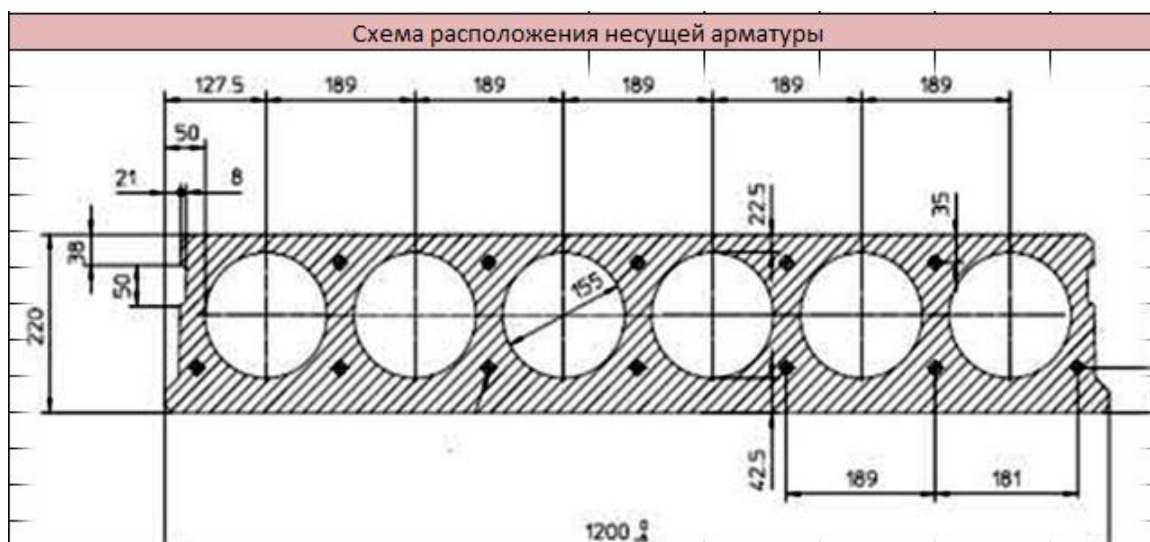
Схема арматурного каркаса плиты перекрытия
